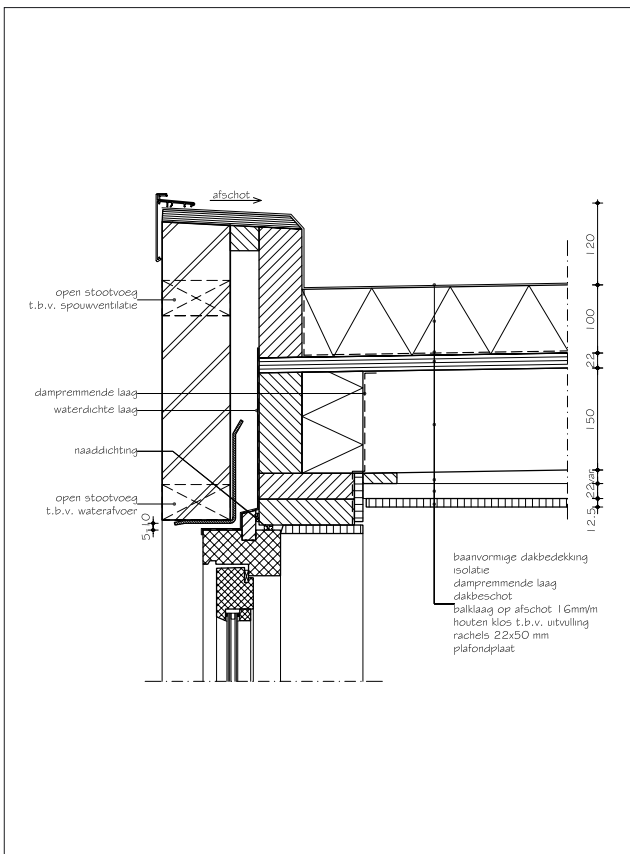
Oplossing hoekaansluiting vloer/wand bij buitenspouwblad van metselwerk.
